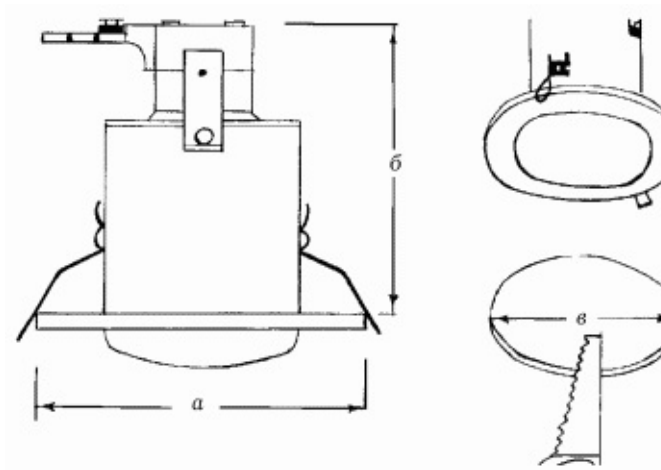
Точечный неповоротный светильник под лампу накаливания с защитным кожухом: а – диаметр светильника; б – глубина установки; в – диаметр отверстия.
